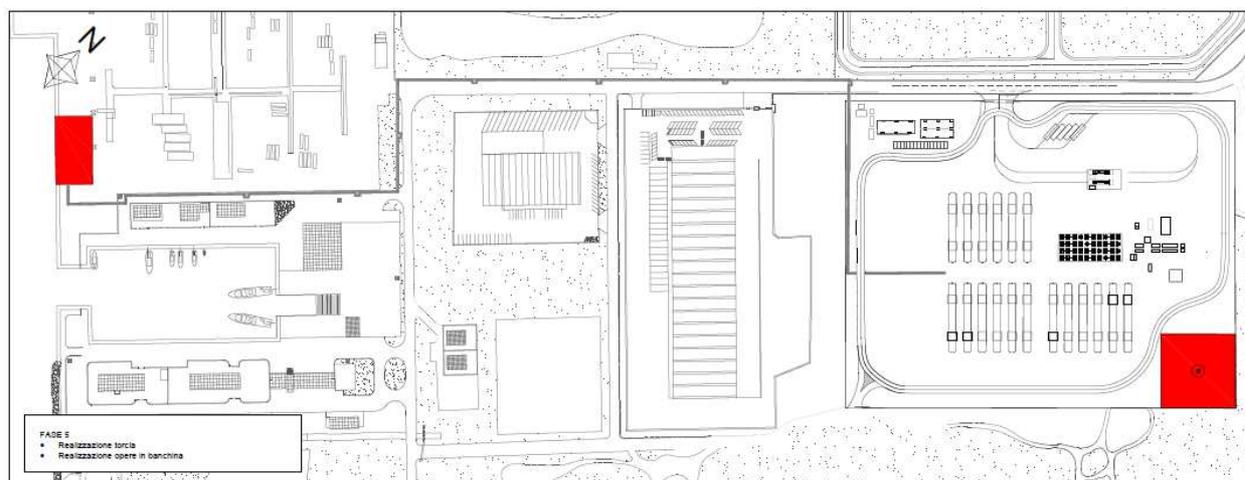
Fase 5. Area oggetto delle lavorazioni previste.
